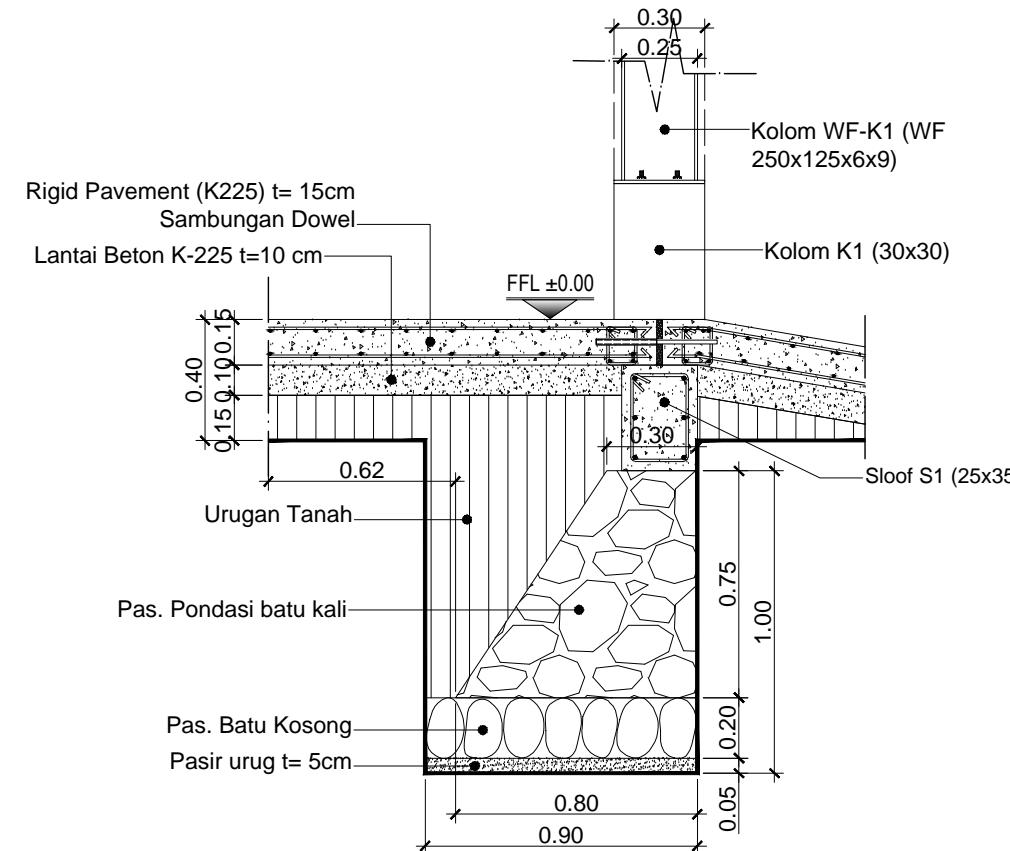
DETAIL FOOTPLATE & PONDASI BATU KALI | DETAIL = 1 : 25
